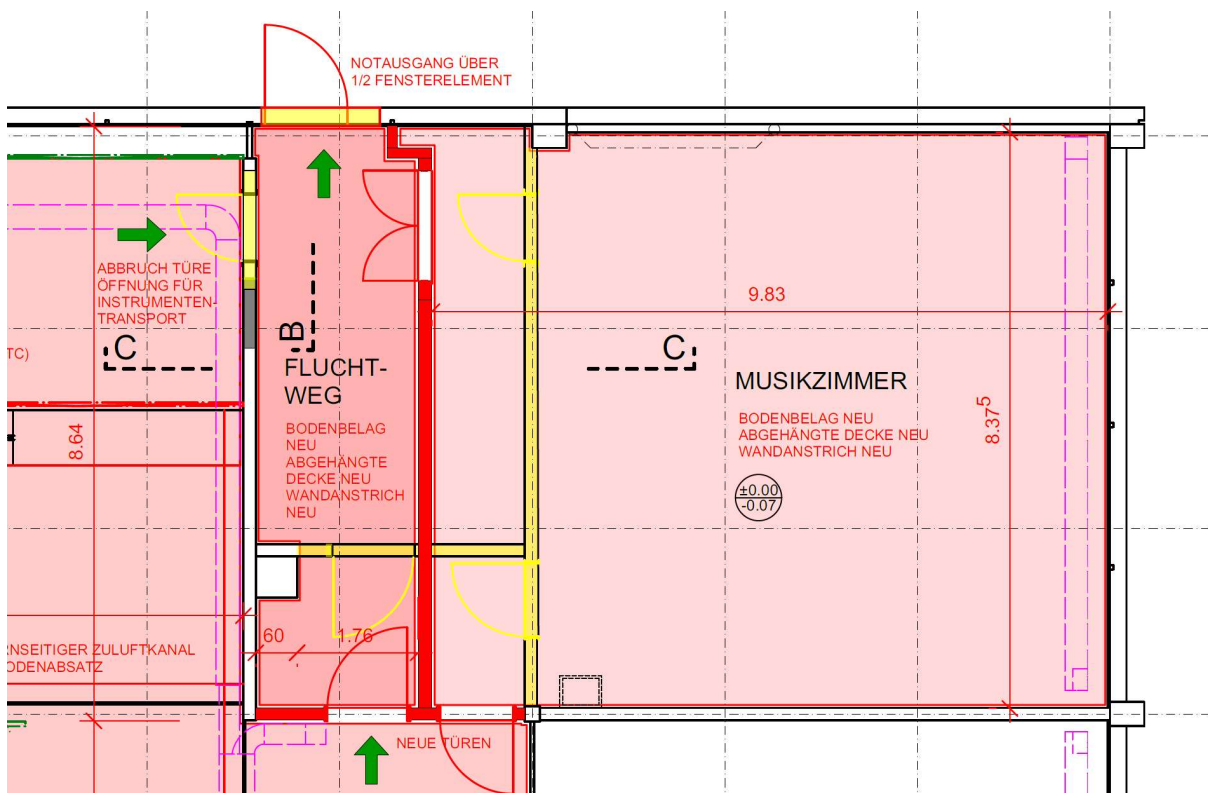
, Planausschnitt: Grundriss Bereich Musikzimmer, Zwischenraum
